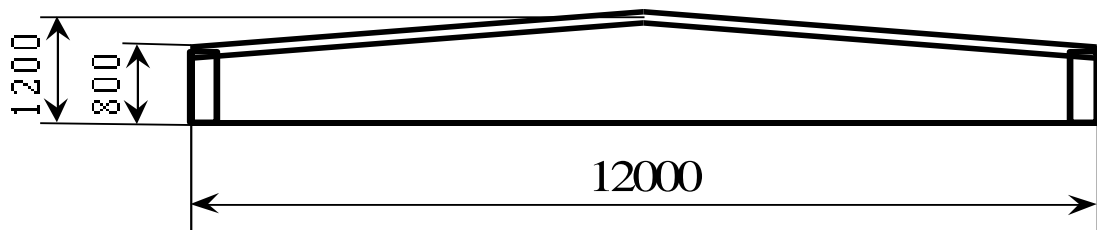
Залізобетонна балка скатних покрить
